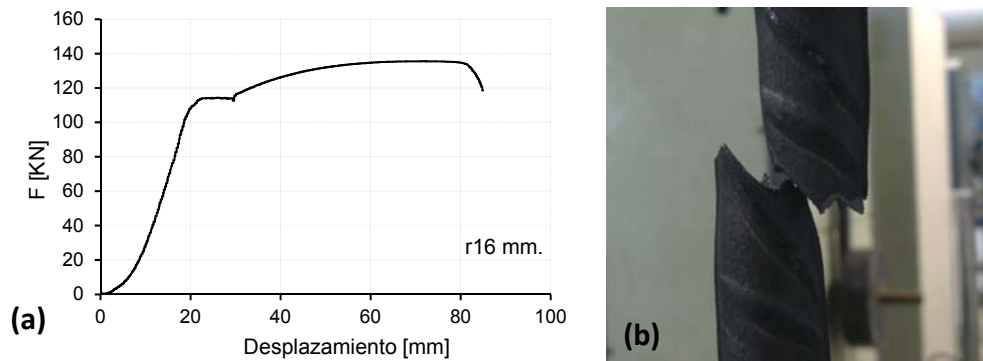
Ensayo de tracción de la armadura diámetro nominal 16mm. a) curva fuerza-desplazamiento. b) estricción de la barra
